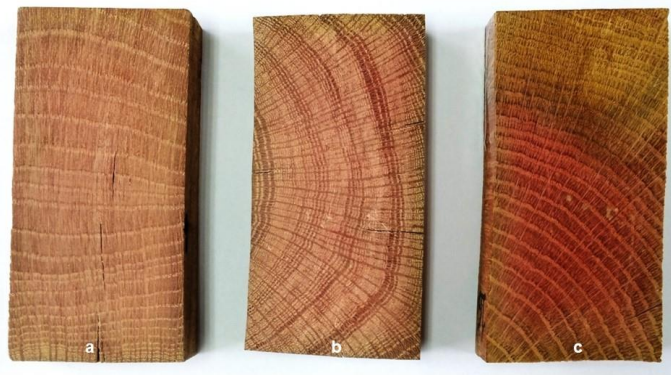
Piezas obtenidas por corte transversal de las vigas ensayadas, con los tres tipos de orientación de anillos: (a) viga obtenida por corte radial; (b) viga obtenida por corte tangencial; (c) viga obtenida por corte mixto. El color rojizo corresponde al duramen y el color amarillento corresponde a la albura, siendo la diferencia de color especialmente visible en la Figura 1c. (Las piezas fueron teñidas tras el secado en estufa).
